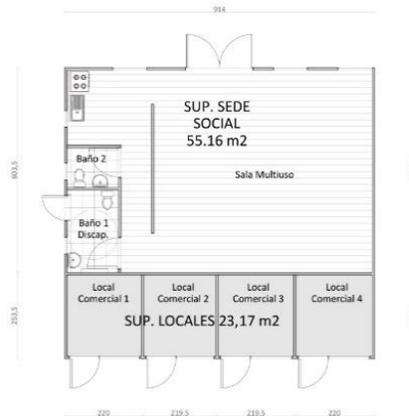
Planta esquemática sede social Altos Cordillera. Fuente: Elaboración propia
